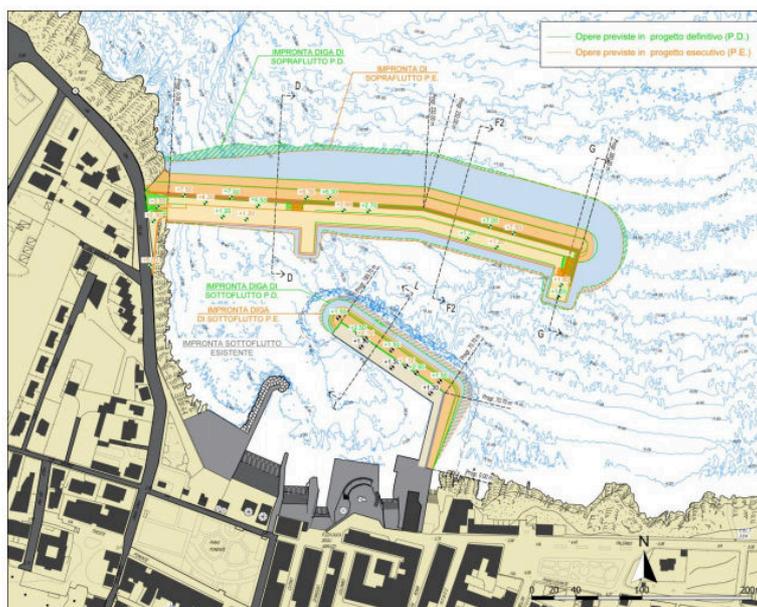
Planimetria di raffronto tra Progetto Definitivo (P.D.) e Progetto Esecutivo (P.E.)
